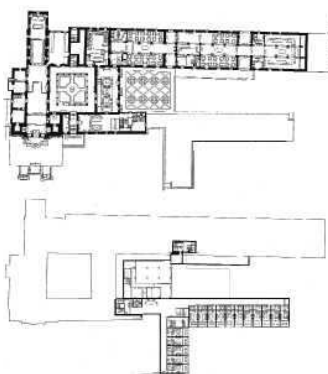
Planta Pousada de Sta. Marinha, Fernando Távora
